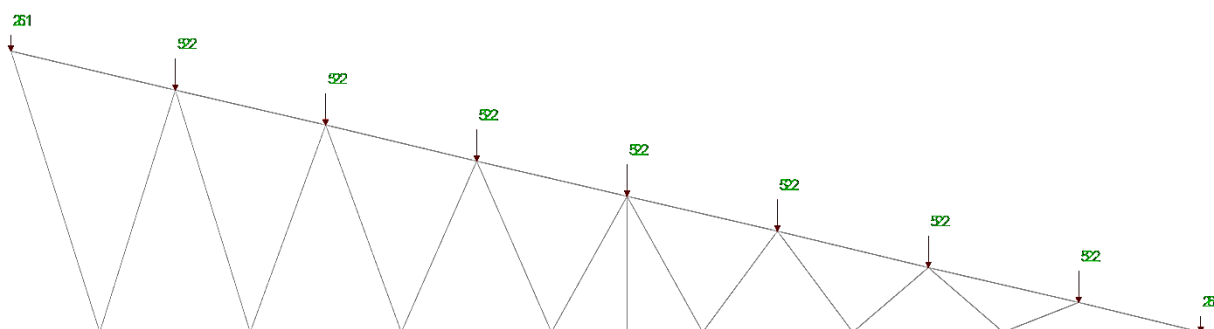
Схема приложения нагрузки от покрытия на ферму
